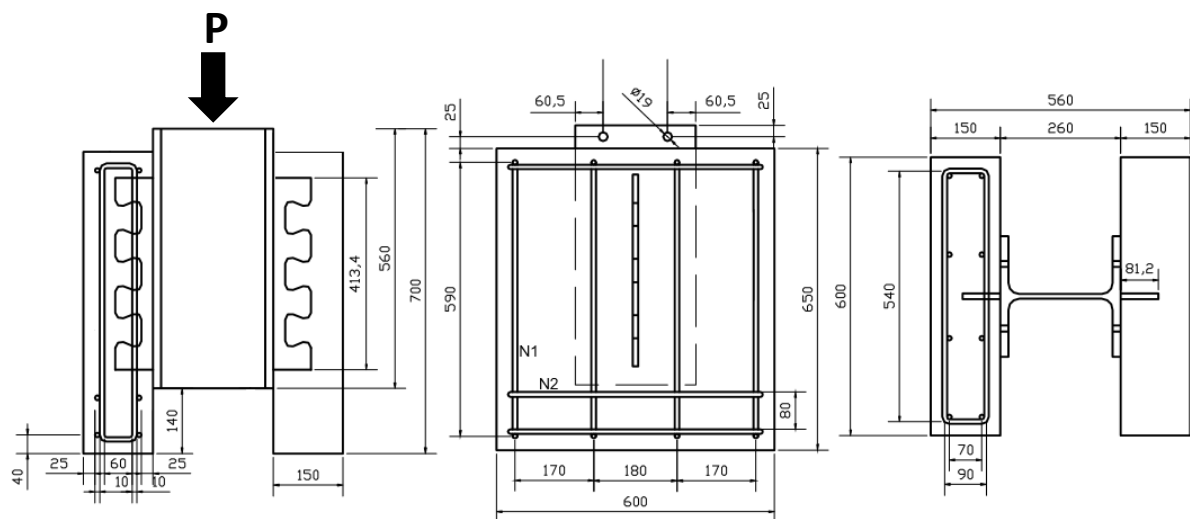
Ensaio de cisalhamento padrão (*standard push test*) (Veríssimo, 2007): (a) vista frontal; (b) vista lateral; (c) vista superior.
